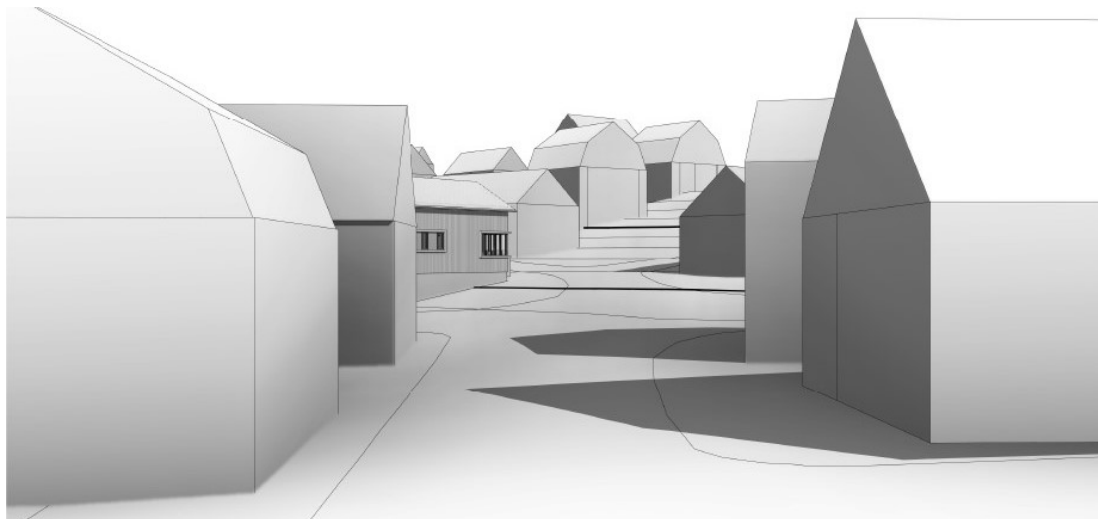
Planlagt bebyggelse sett fra Svanedalsgården.
